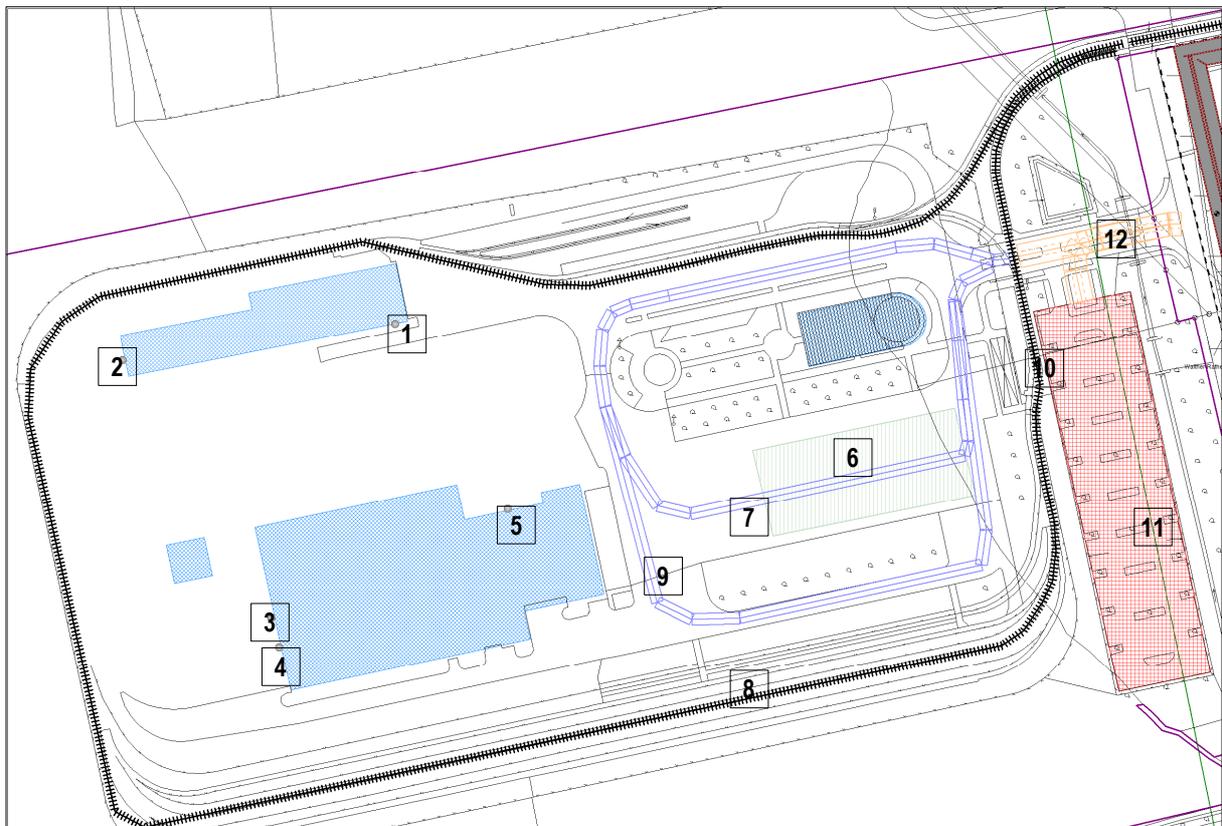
Lageplan (vorläufiges städtebauliches Konzept)
